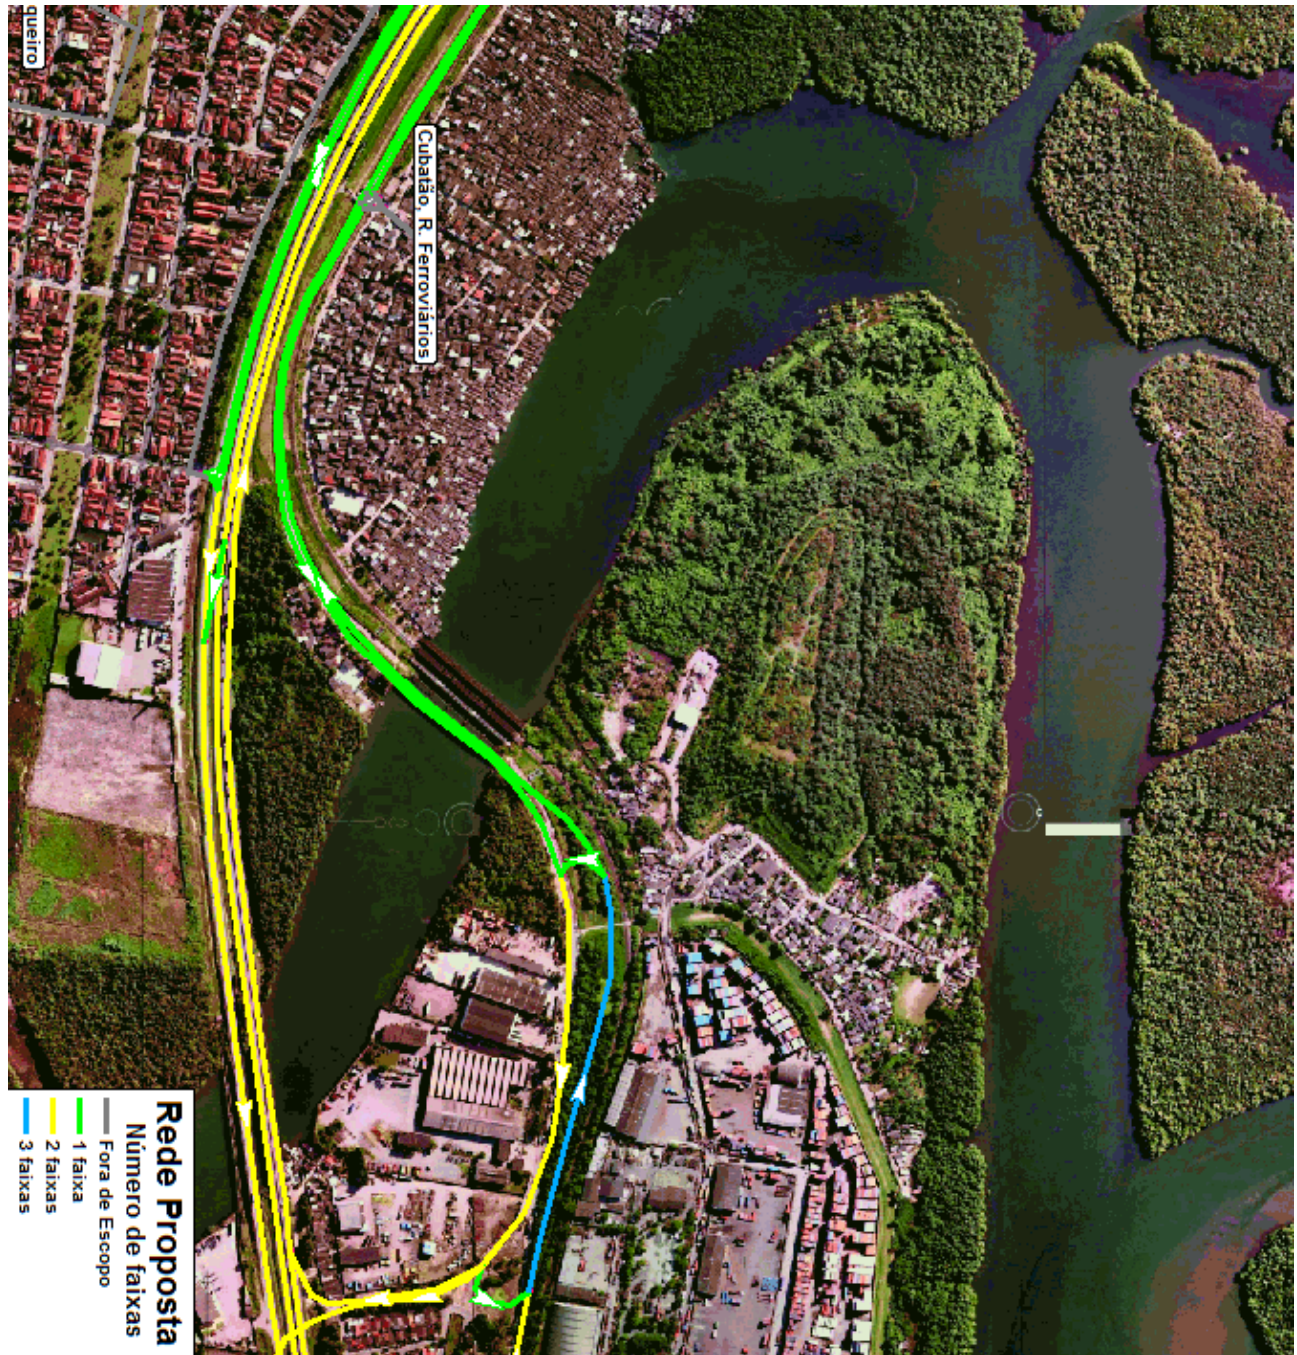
b: Projeto Proposto – Número de Faixas de Rolamento
